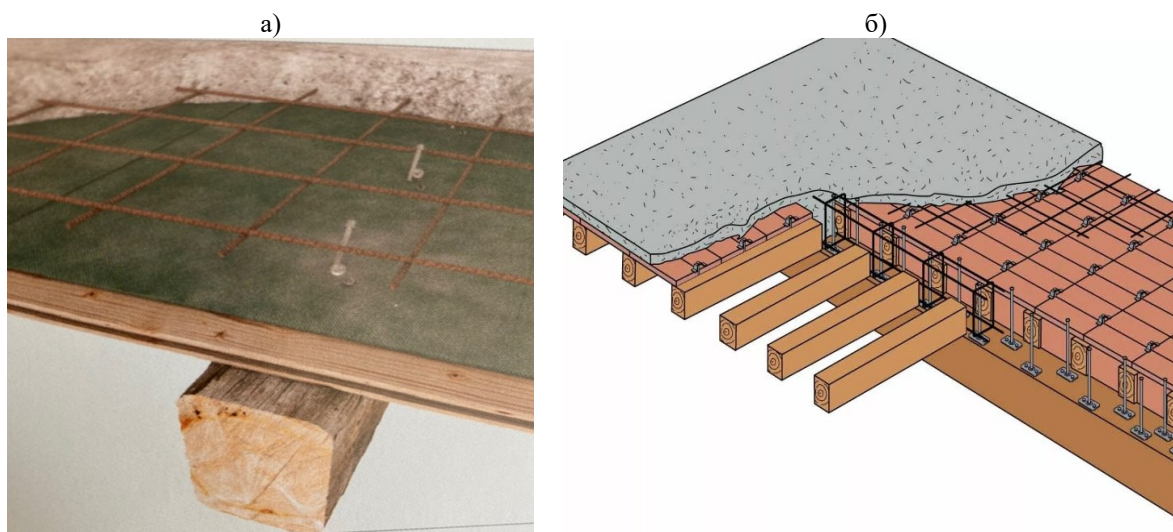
Конструкция дерево-железобетонного перекрытия с устройством плоской монолитной плиты по настилу (а) и с устройством ребристой монолитной плиты для существенного повышения прочности (б)
